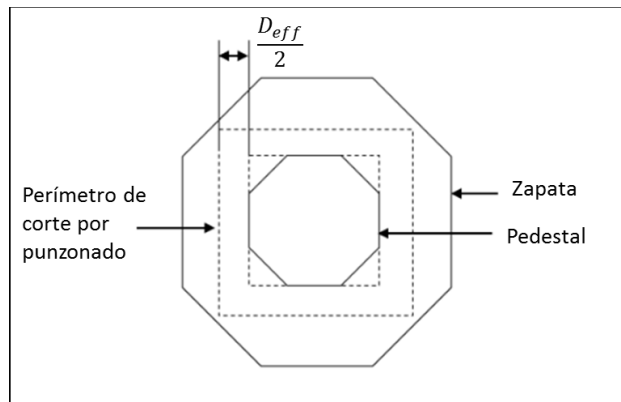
Vista de planta de la fundación. Fuente: STAAD Foundation Advanced.
